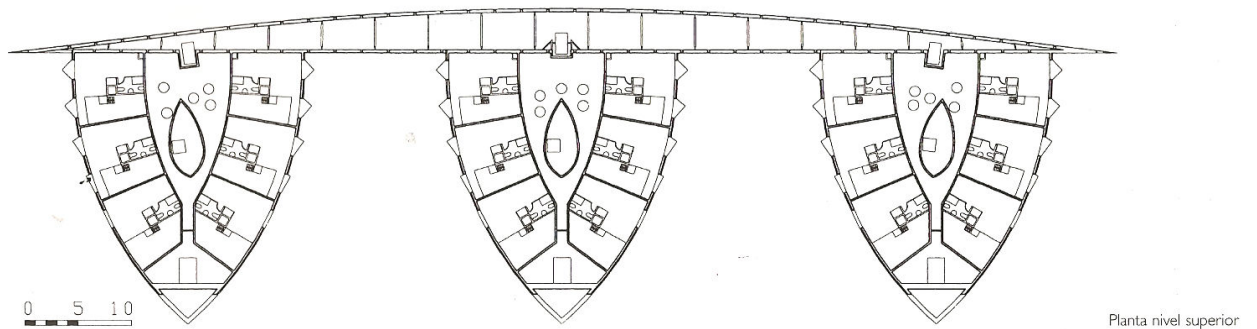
Planta baixa tipo do University Residence.(HUBER, Wilhelm)
